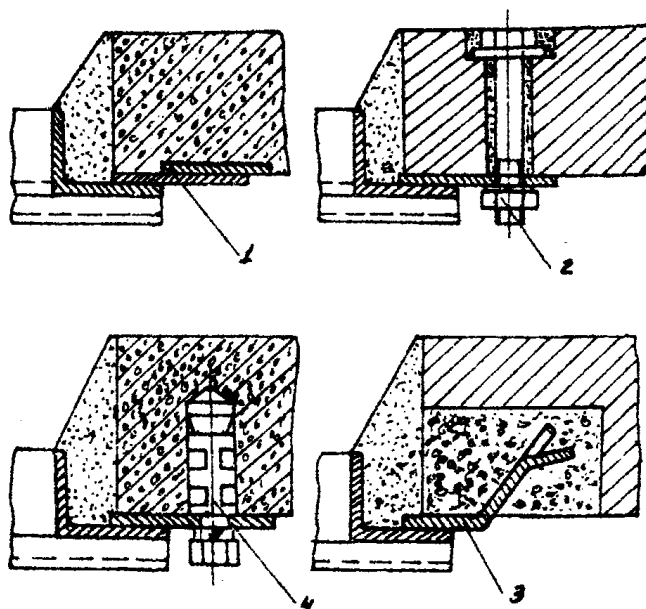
Варианты крепления дверей шахты грузовых лифтов:
